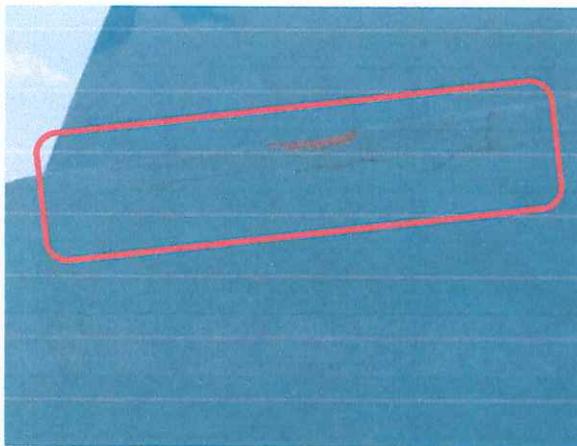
Vista de arista superior del borde reservorio, con fisuras.
